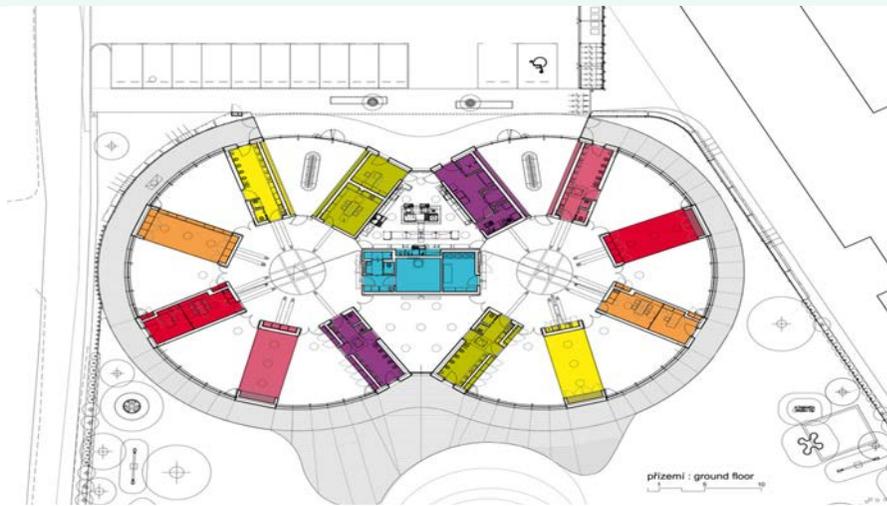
Planta baja. Foto de MTA, 2022, ArchDaily.
